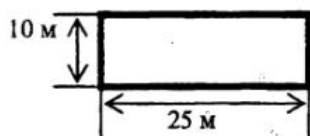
План прямоугольного котлована: 10 и 25 – размеры дна котлована в плане
